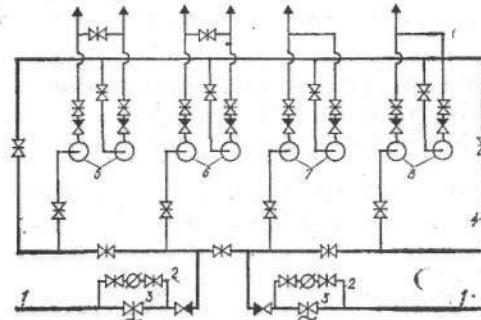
Установка насосов противопожарных водопроводов в зданиях повышенной этажности
